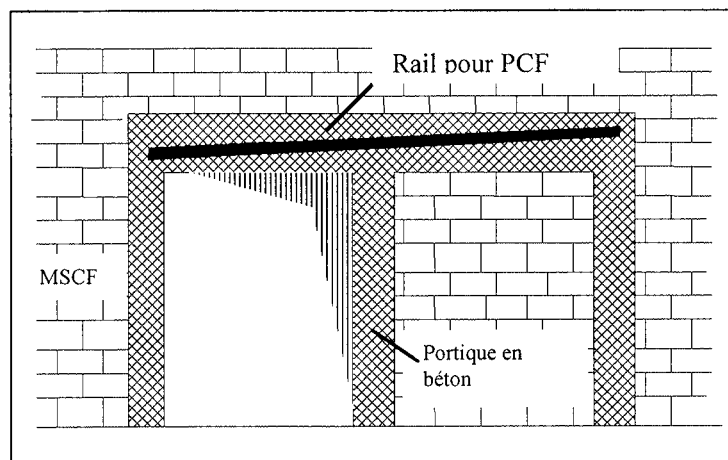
b. : Exemple de mise en place d'une porte coupe-feu sur un MSCF.
